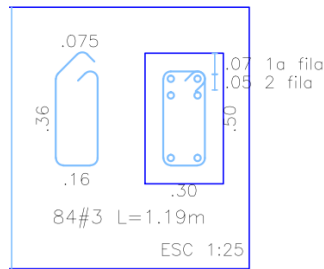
Detalle flejes viga de cimentación Eje 2. Fuente: Planos del proyecto
